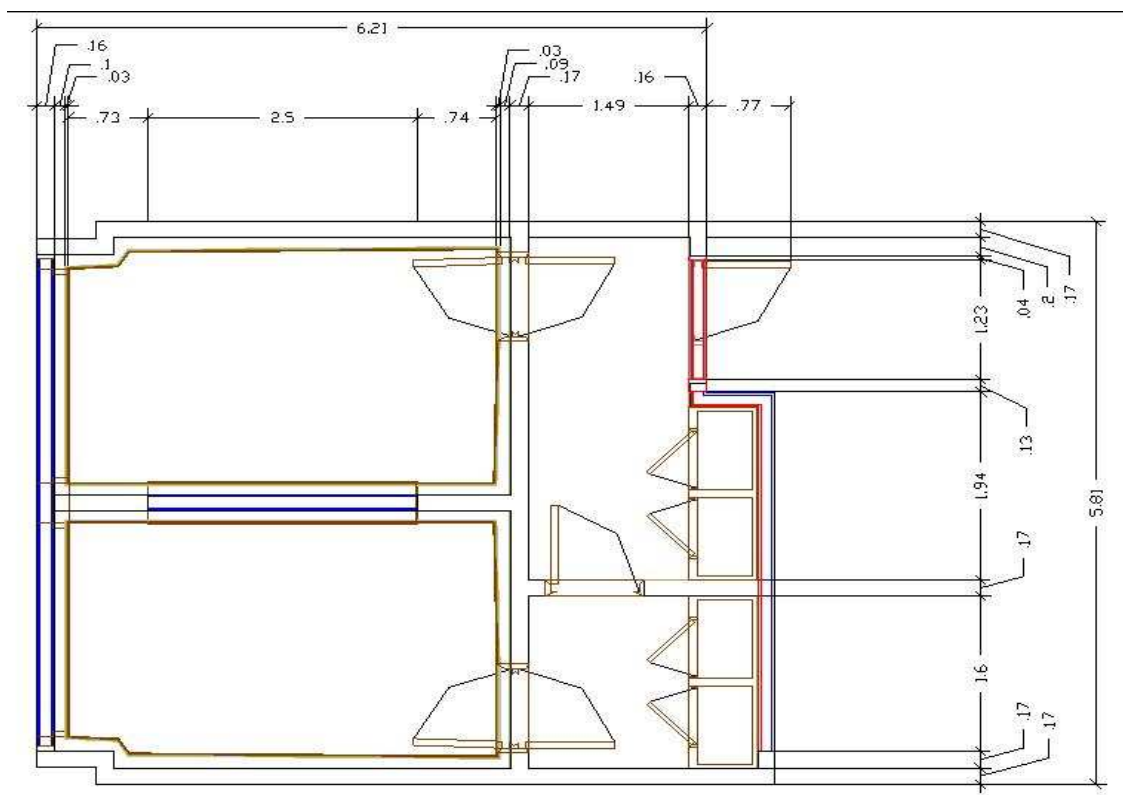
PLANTA Y DISPOSICION INTERNA DEL DISEÑO DE LA PROPUESTA
